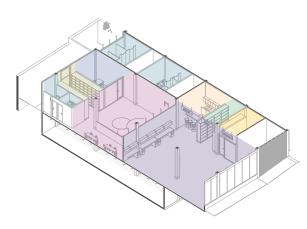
Zonificación 3D, zona de guardería y talleres de capacitación. Fuente: Autores, 2024
